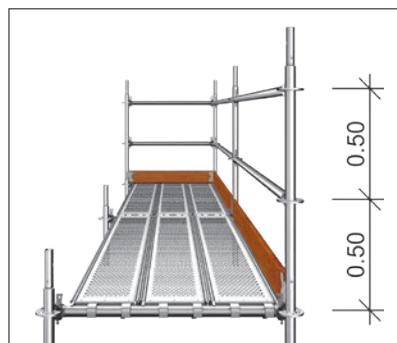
Dreiteiliger Seitenschutz im AllroundGerüst
